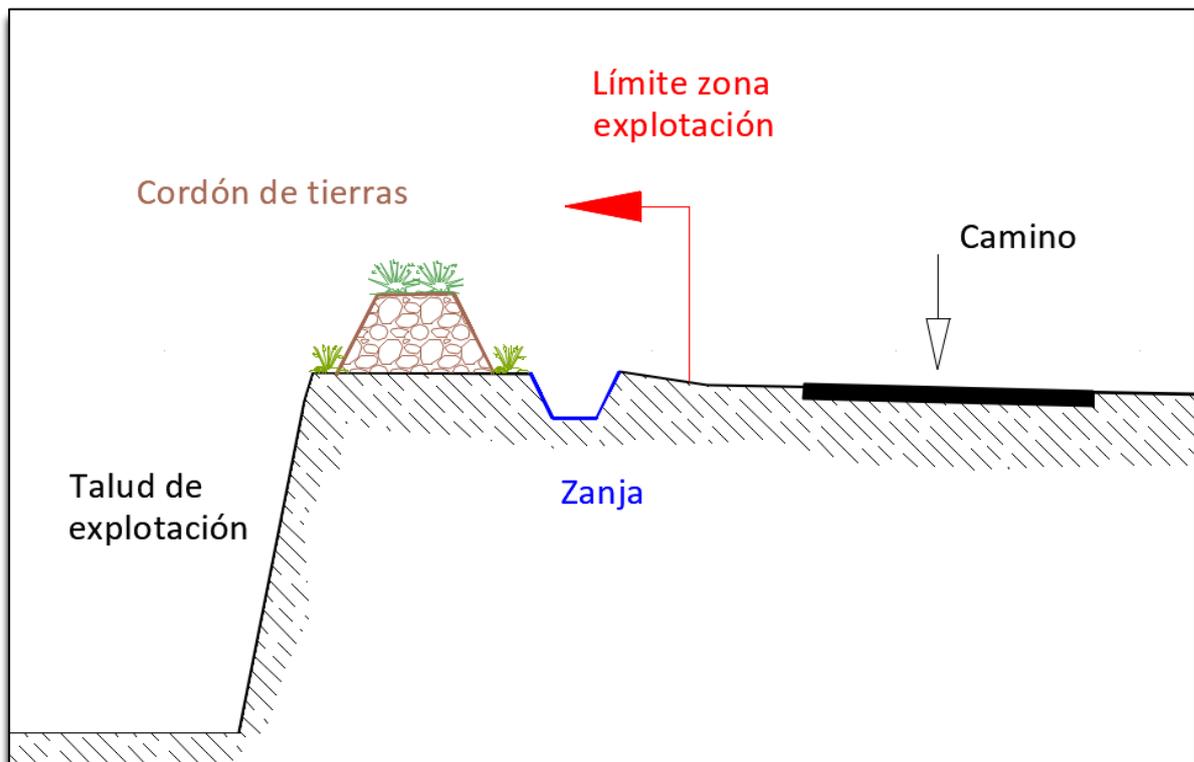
Esquema tipo del perímetro del hueco de excavación. Alzado.
